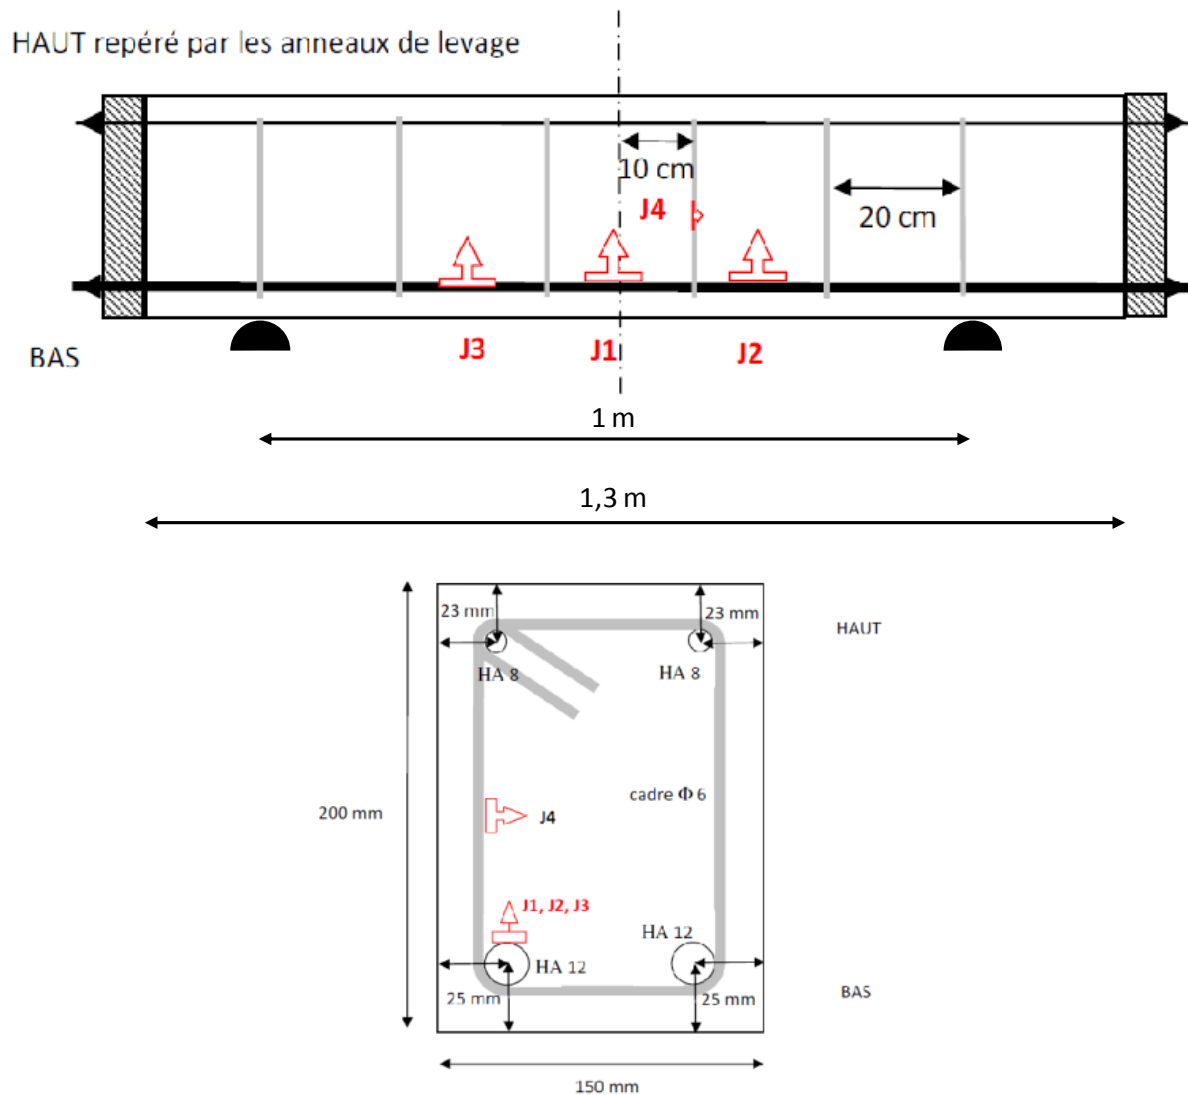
Géométrie de la poutre et plan du ferrailage de la section (Piteau et Valin, 2011).
